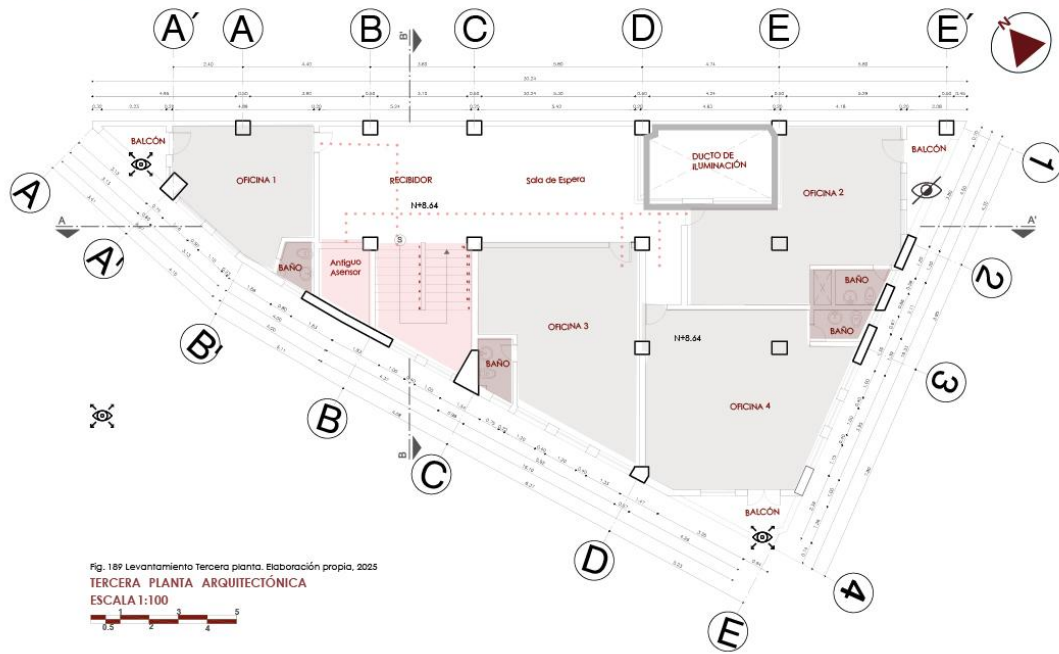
Levantamiento Tercera planta. Elaboración propia, 2025
